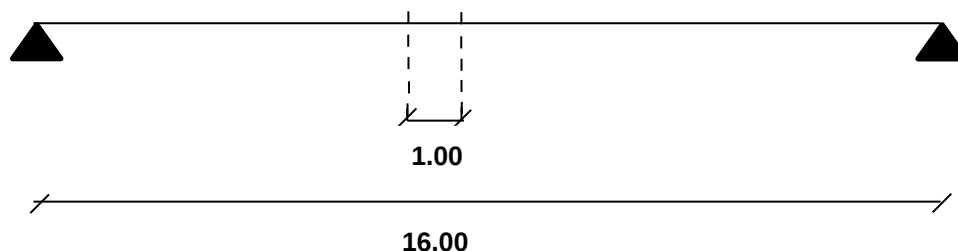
Esquema simplificado, franja longitudinal del puente que se toma para el cálculo.
